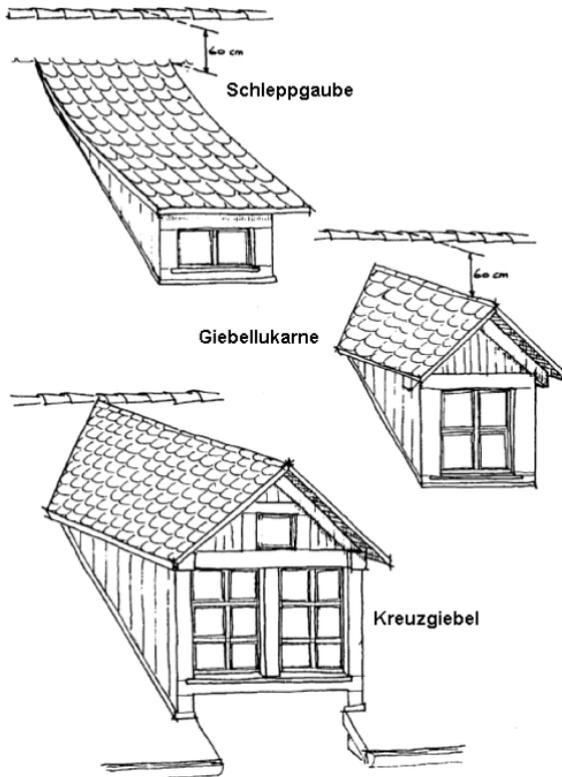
Beispiele für Dachaufbauten/Dachformen
